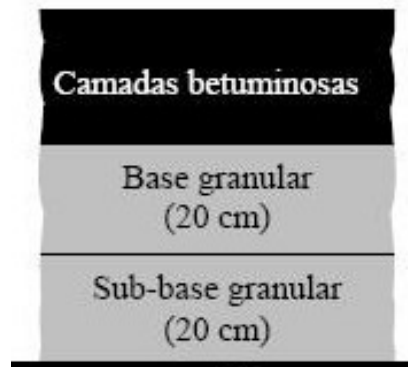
Pavimento flexível de base granular (Picado-Santos, 2002)
